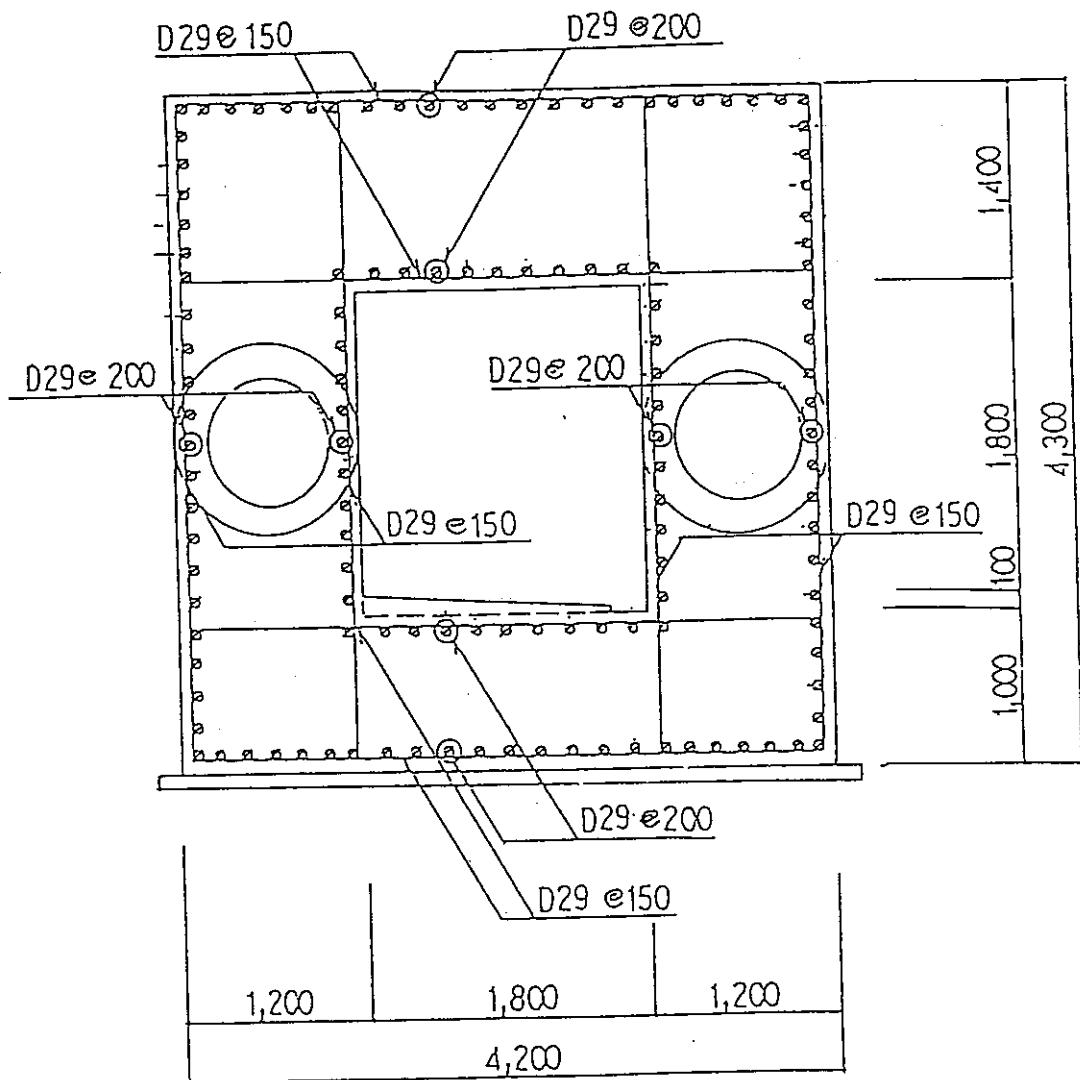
配管トレーンチ (T 21) 配筋・型枠検査対象位置図
